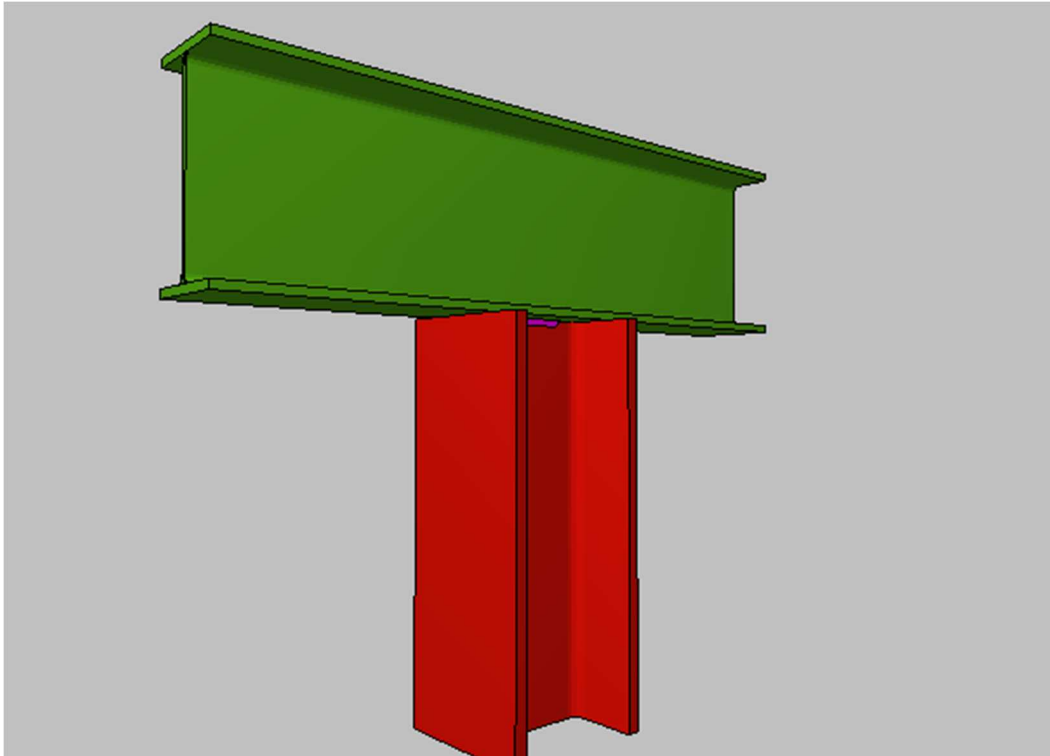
Unión tipo 5 soporte superior. Pilar-viga
